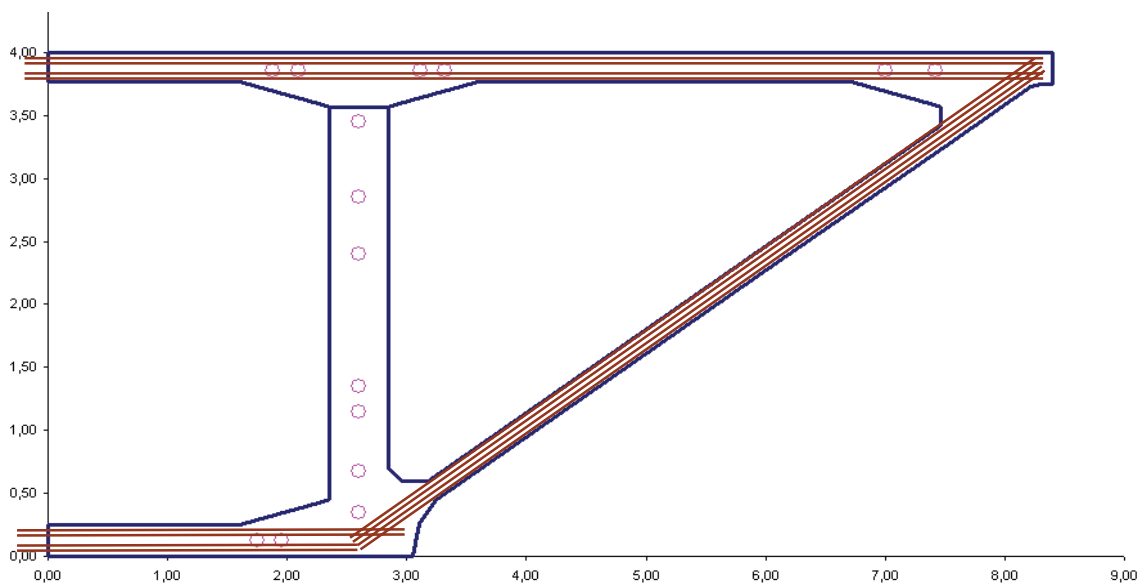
Principe de ferrailage - deuxième zone (section courante)
